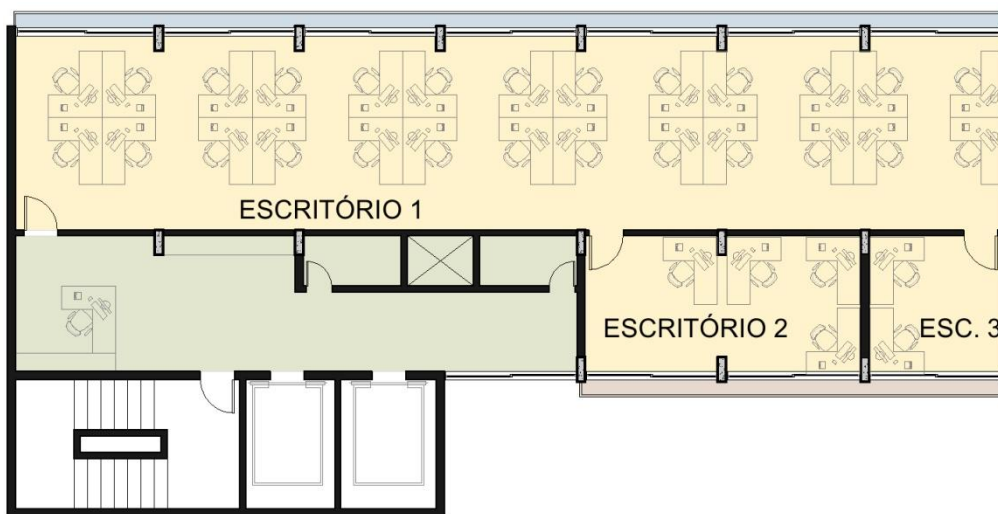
Planta do pavimento tipo com subdivisão da zona do escritório.
